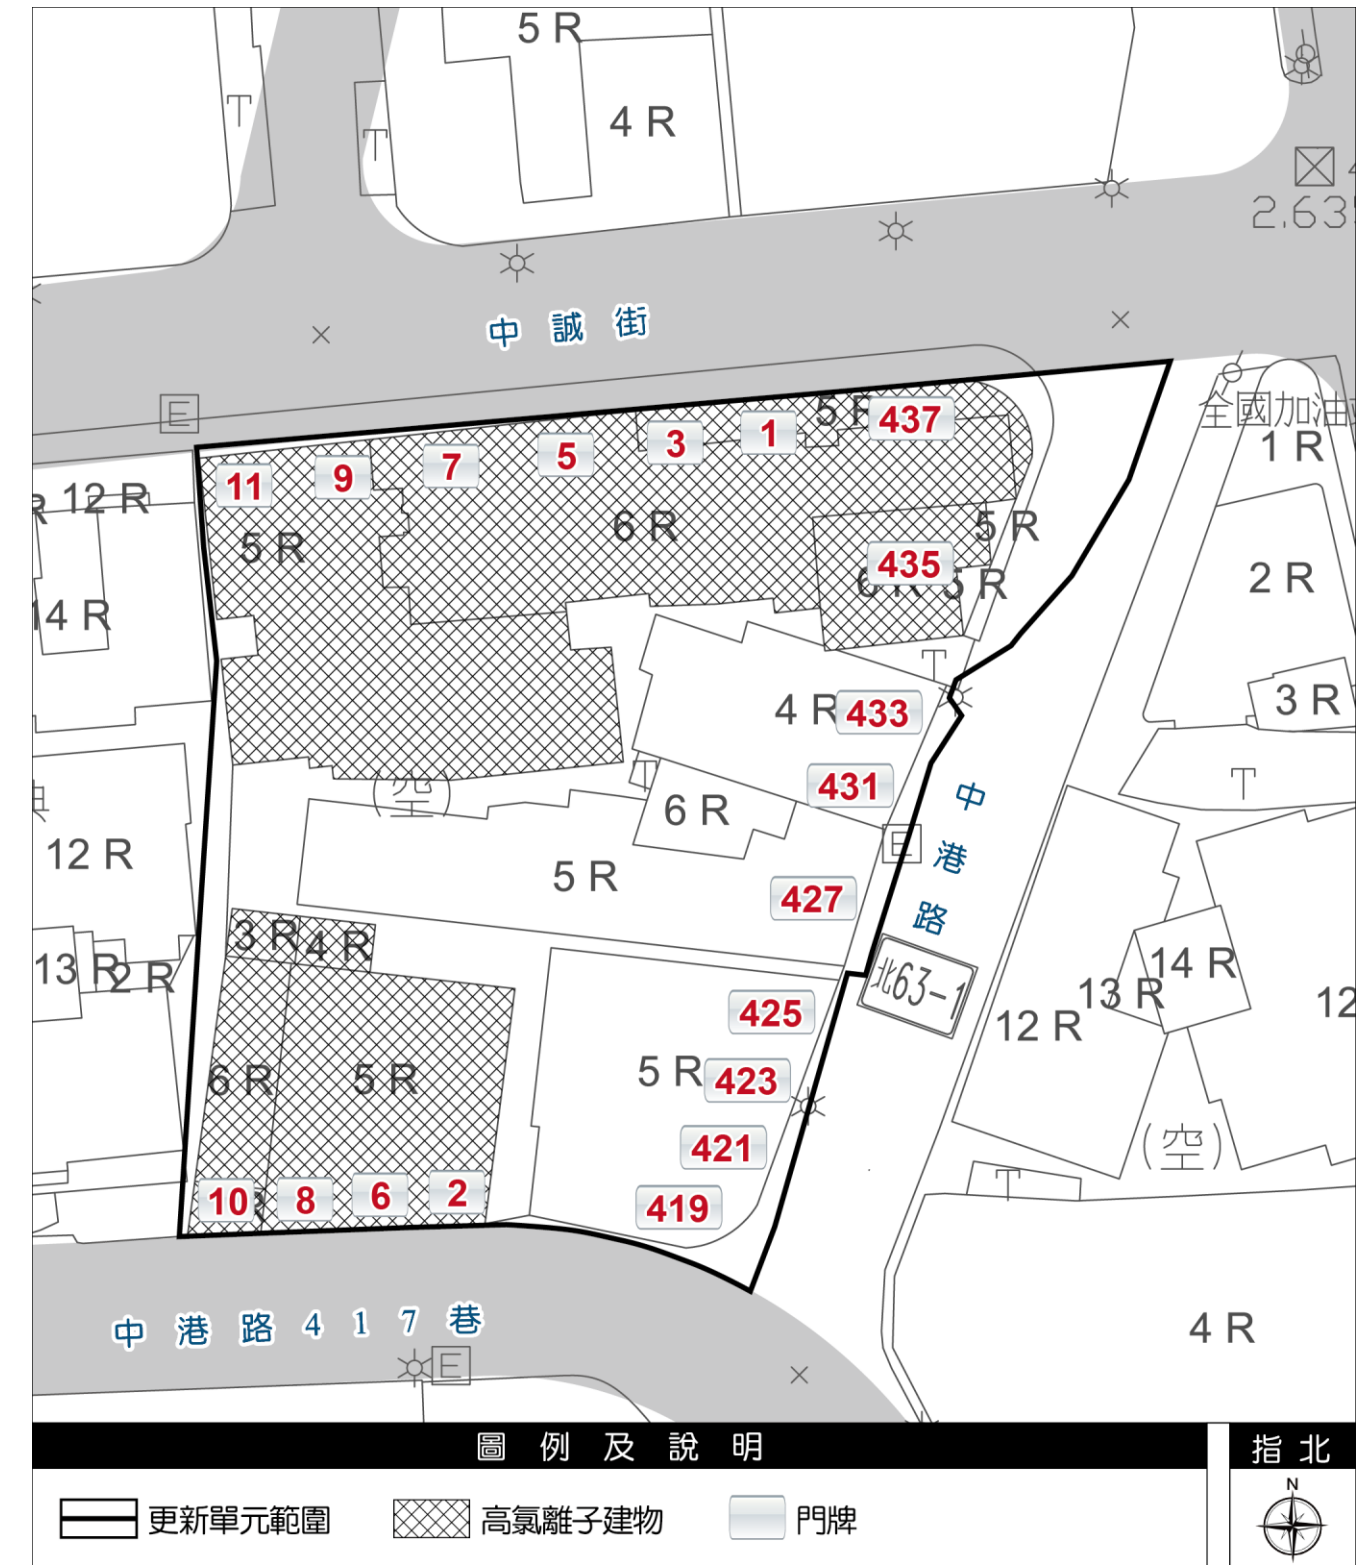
高氯離子鋼筋混凝土建築物座落位置示意圖
